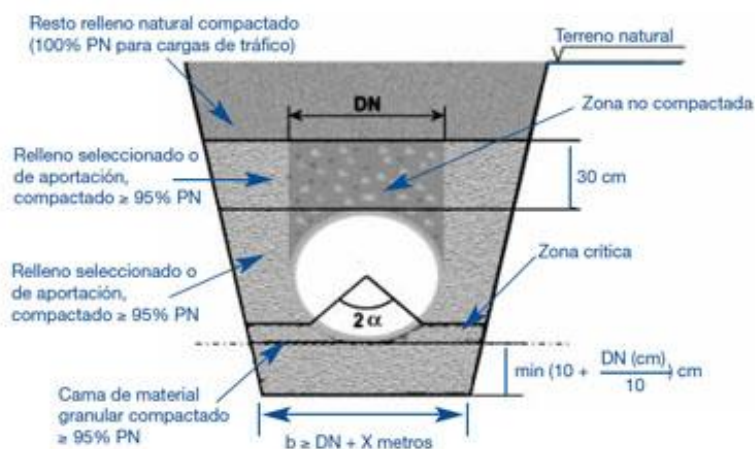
"Zanja tipo para tubería enterrada de PRFV" (Adecua Uralita)
